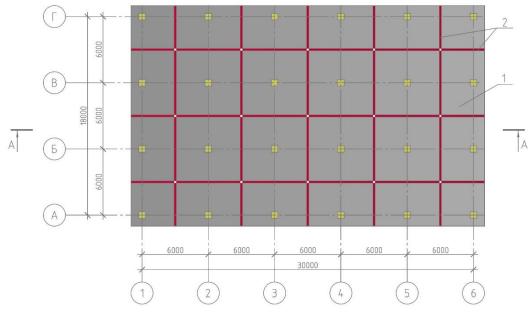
Конструкция фундаментной плиты с регулируемыми усилиями, план: 1 – железобетонная плита; 2 – узел шарнирного действия
